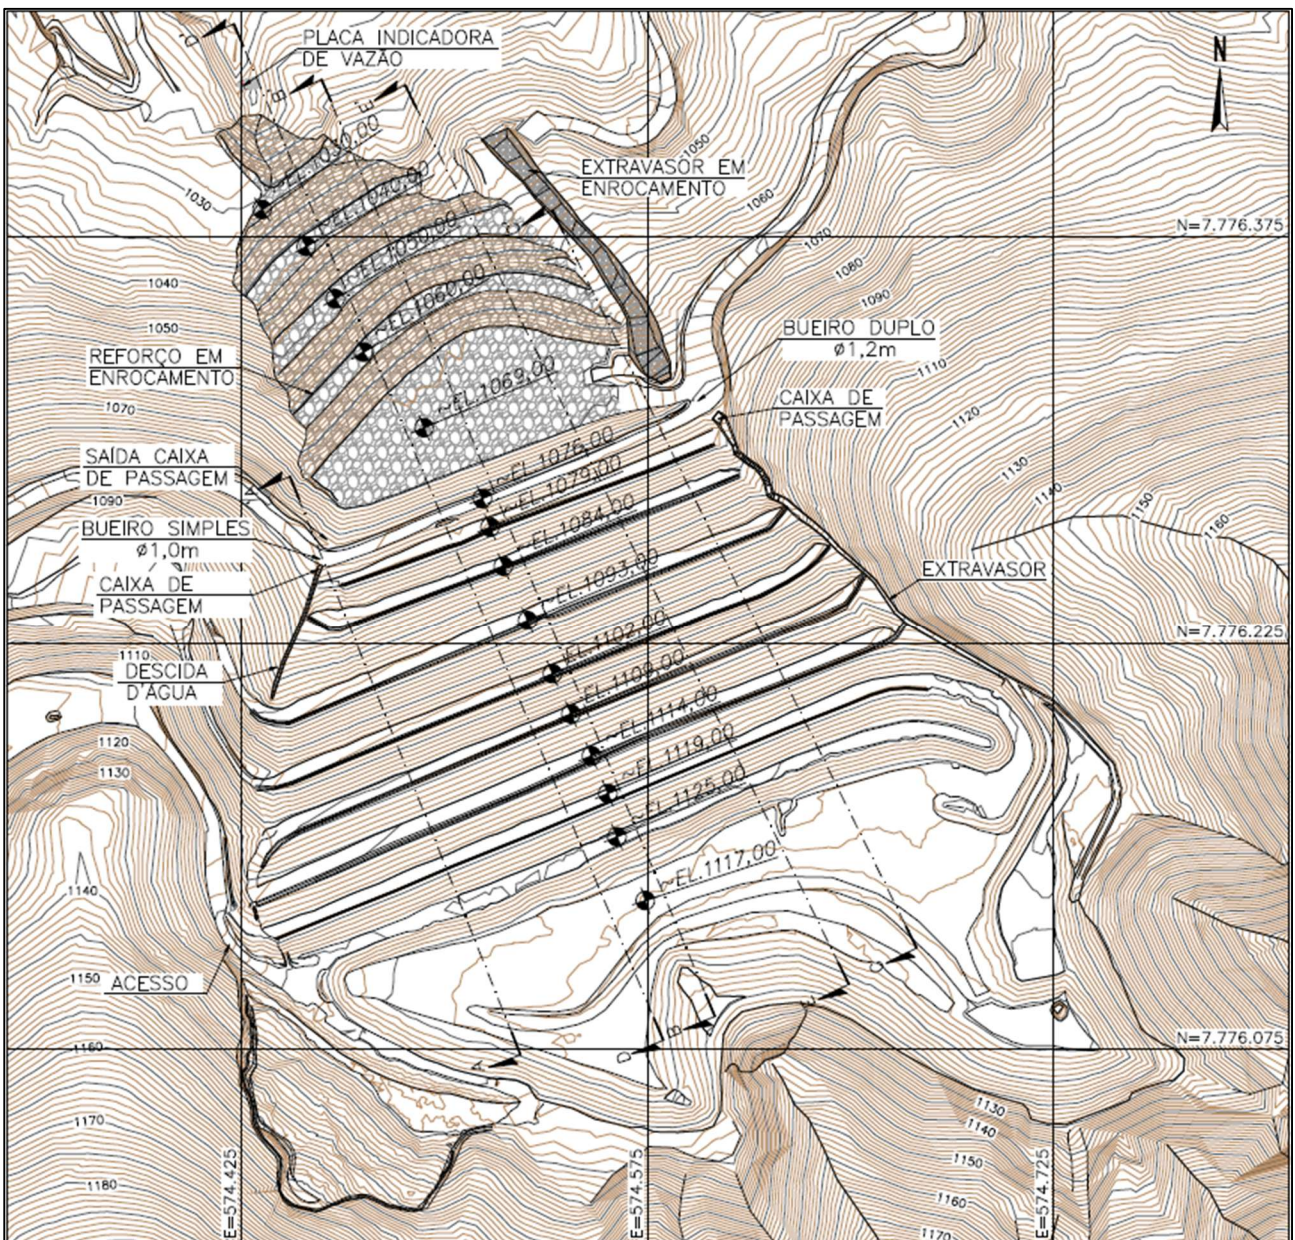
Levantamento topográfico 27/01/25 – Obras Executadas - Planta.
